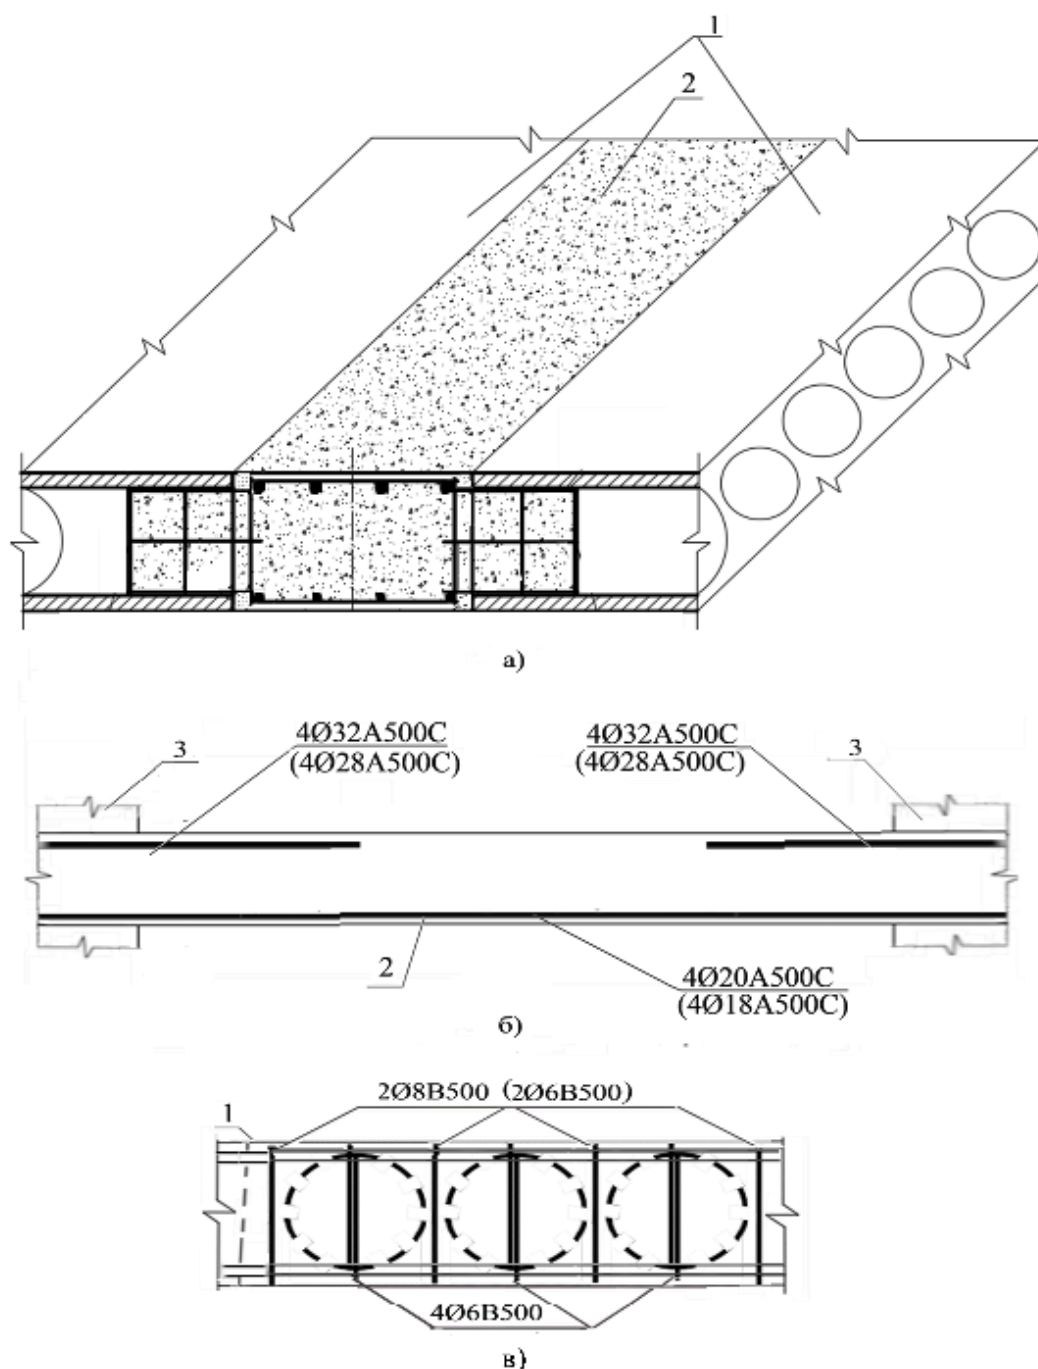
З'єднання плит із ригелем (а); схема армування ригеля поздовжньою арматурою (б); на ділянці біля опори поперечною арматурою (в)
